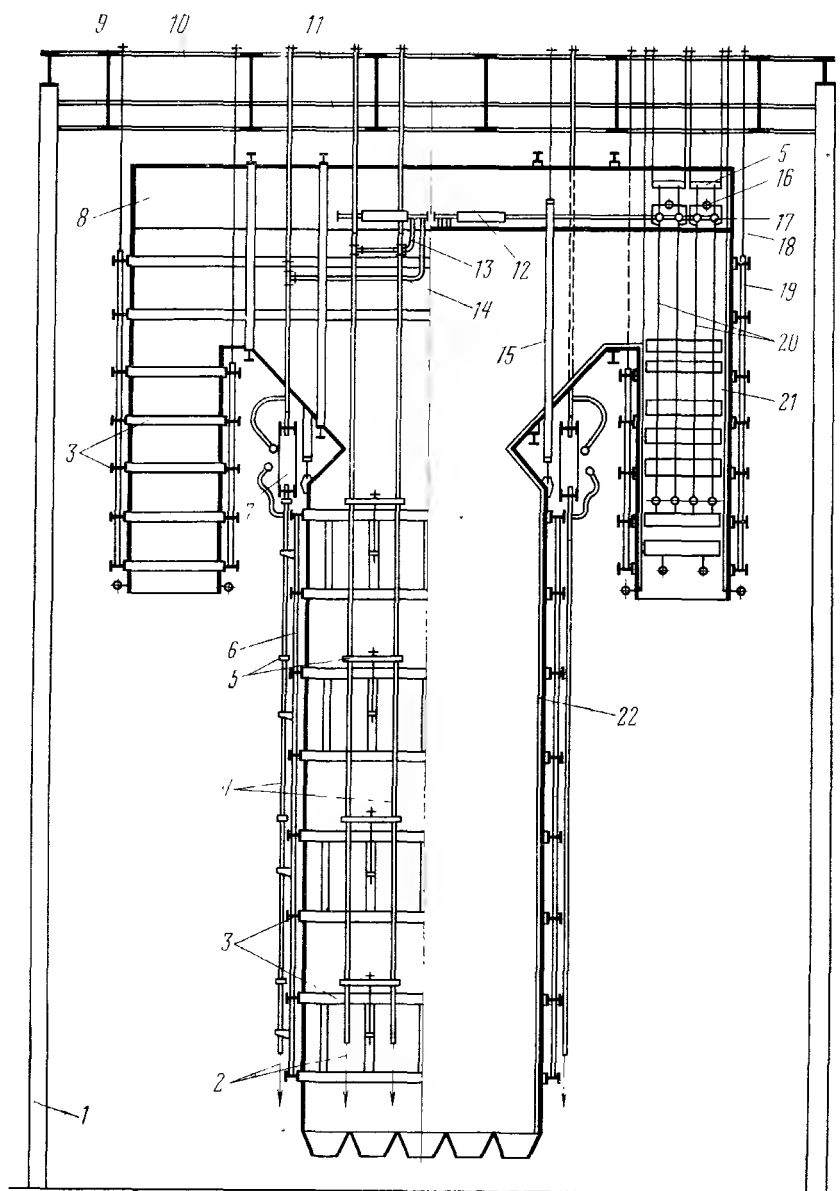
Совмещенный со зданием каркас газоплотного котла П-67 ($D=2650$ т/ч).
